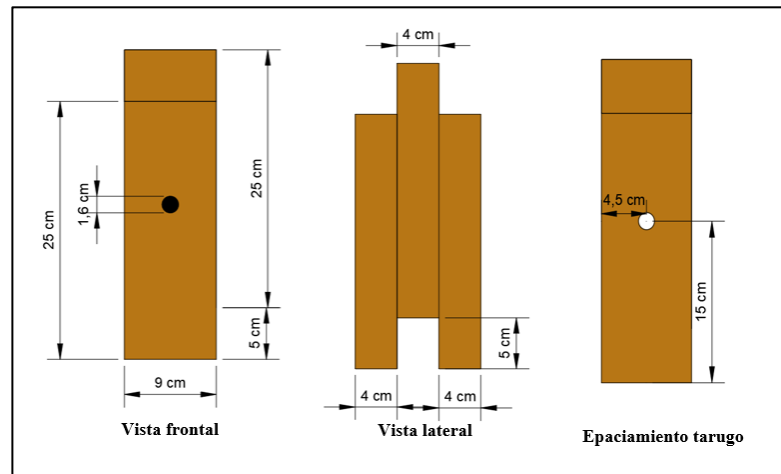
Vistas con detalles de probeta con un tarugo
